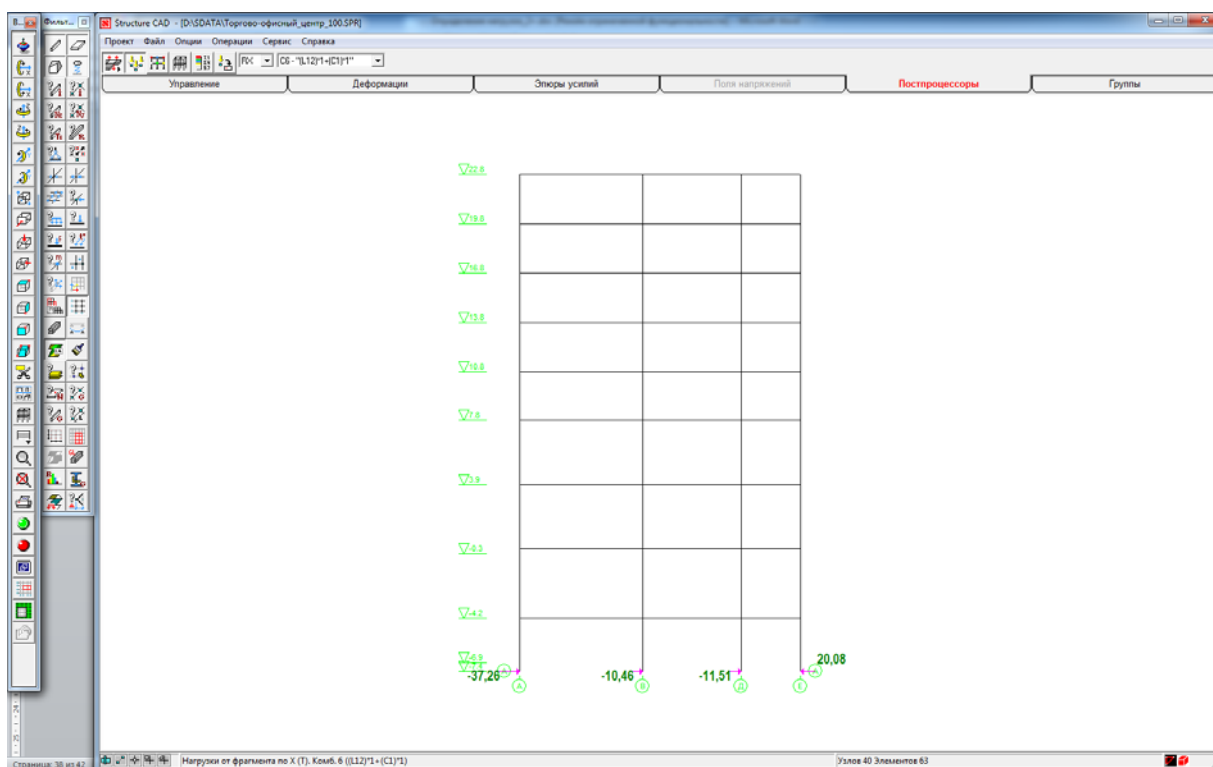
Вертикальные нагрузки на фундаментах колонн от шестой комбинации нагрузок (все вертикальные нагрузки + ветер справа).
